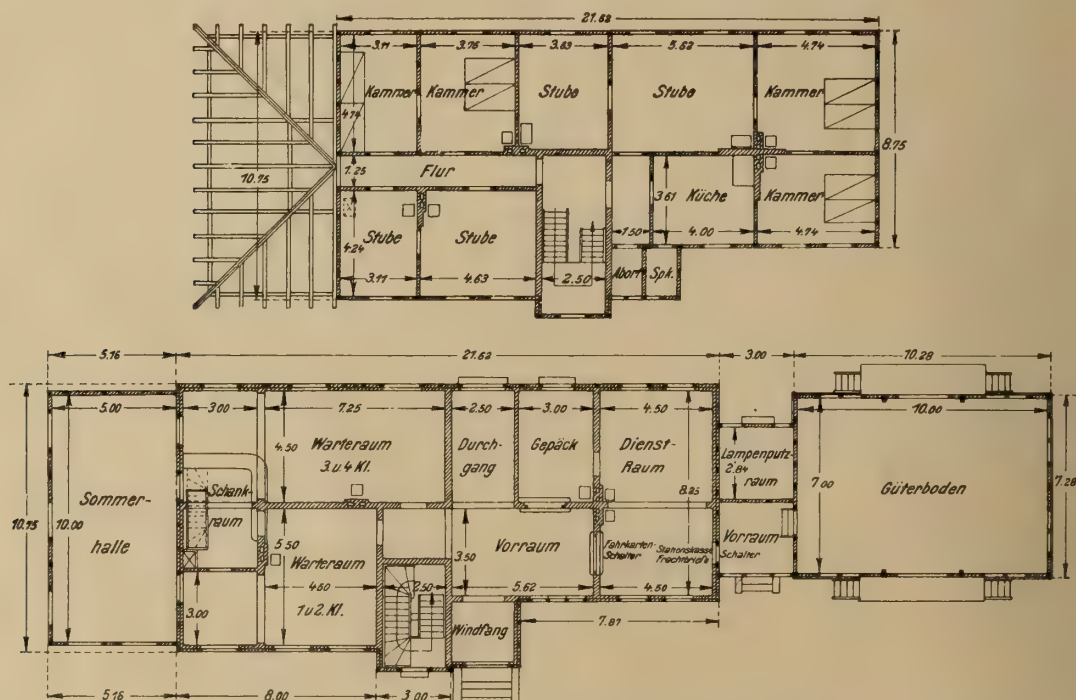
Grundrisse für Empfangsgebäude Altenau
